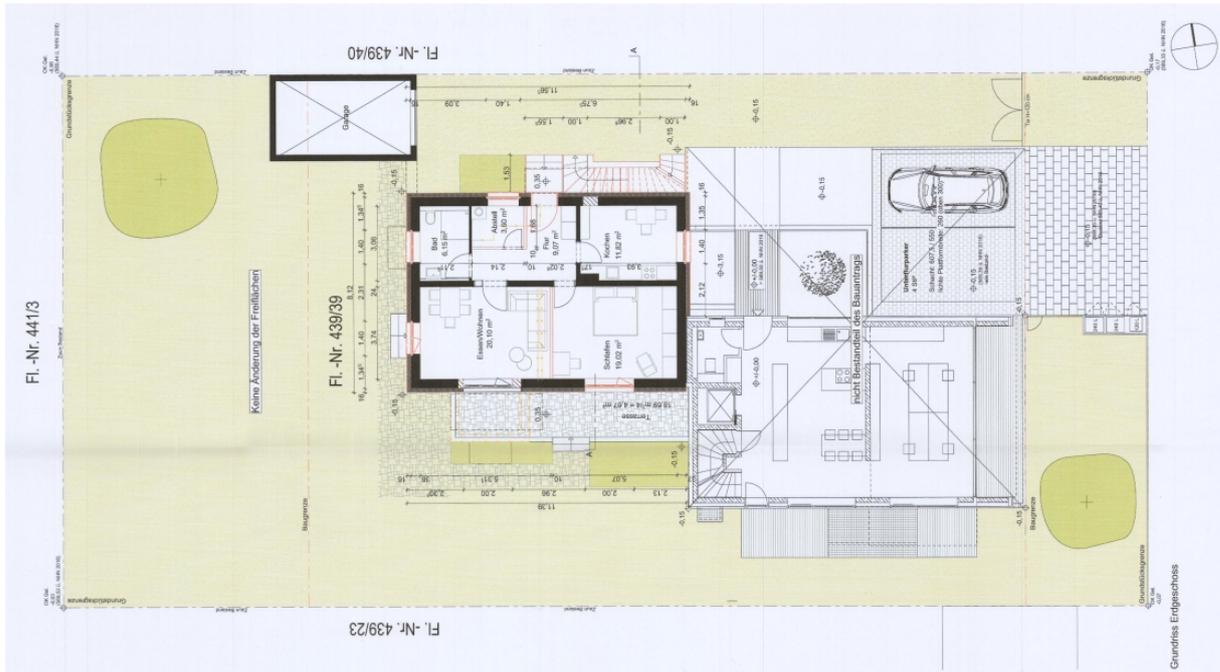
Ausschnitt Freiflächengestaltung Eingabeplan
